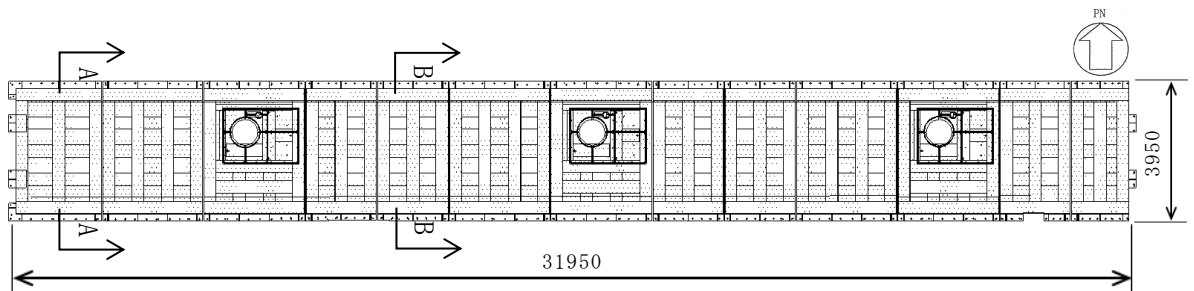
取水槽循環水ポンプエリア防護対策設備の概略平面図 (単位:mm)
